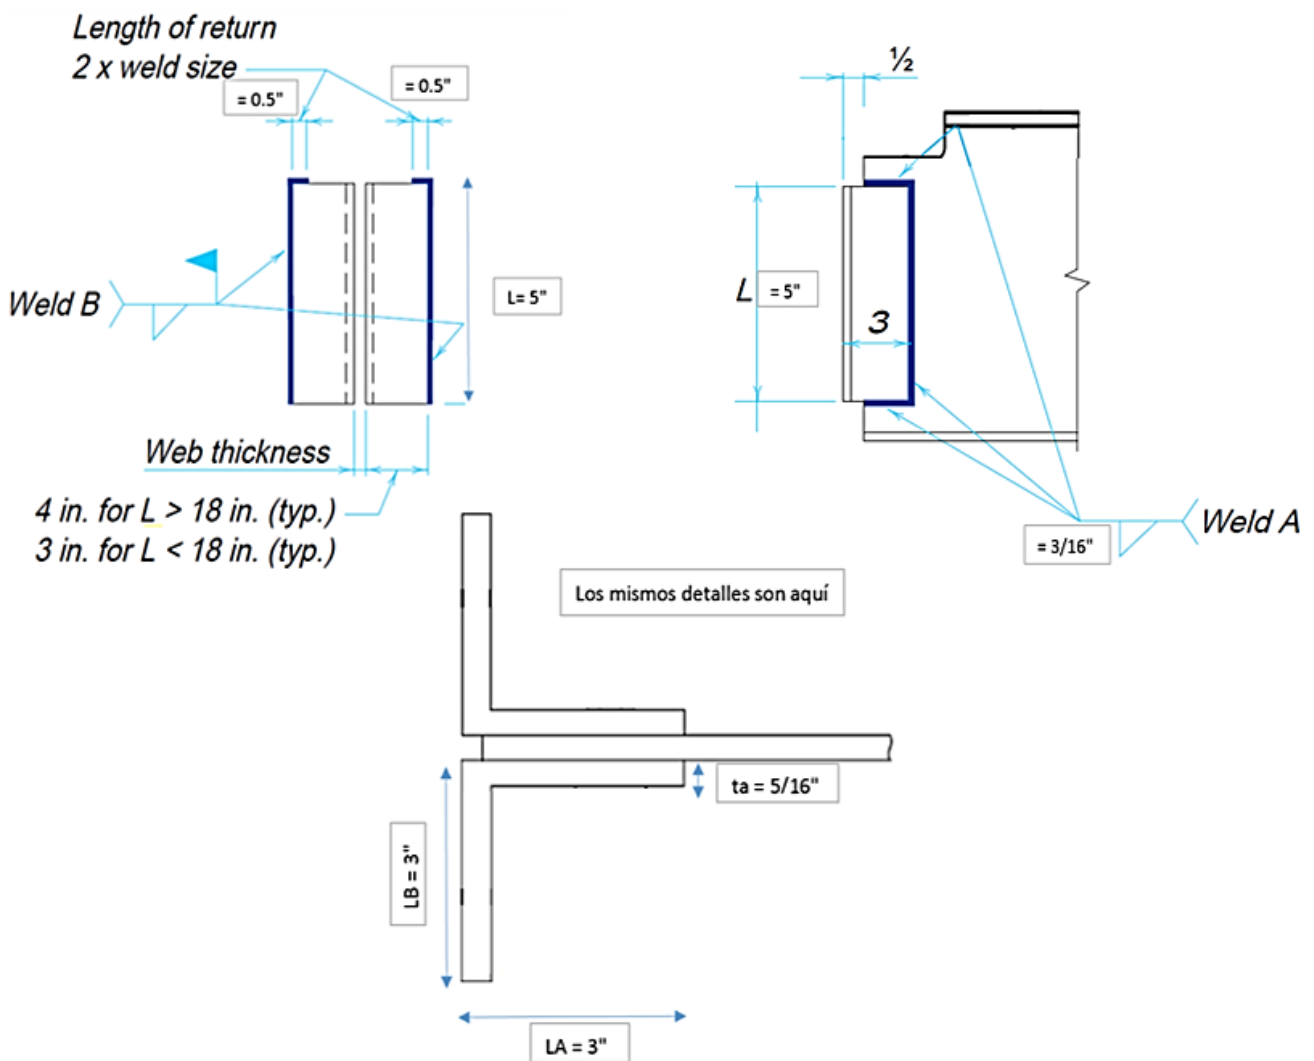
Detalle de conexión simple viga – vigueta doble ángulo totalmente soldada
